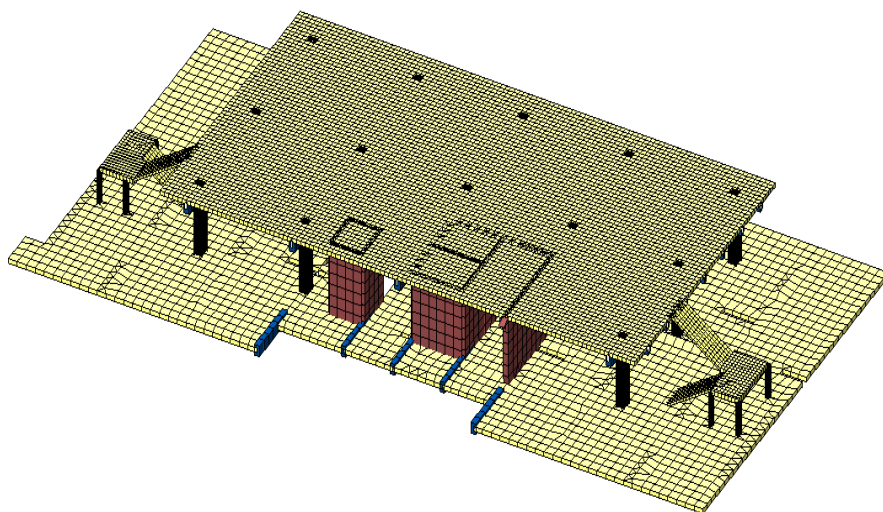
Фрагмент конечно-элементной схема каркаса в ПК «ЛИРА-САПР» (Плита покрытия и вертолетная площадка)
